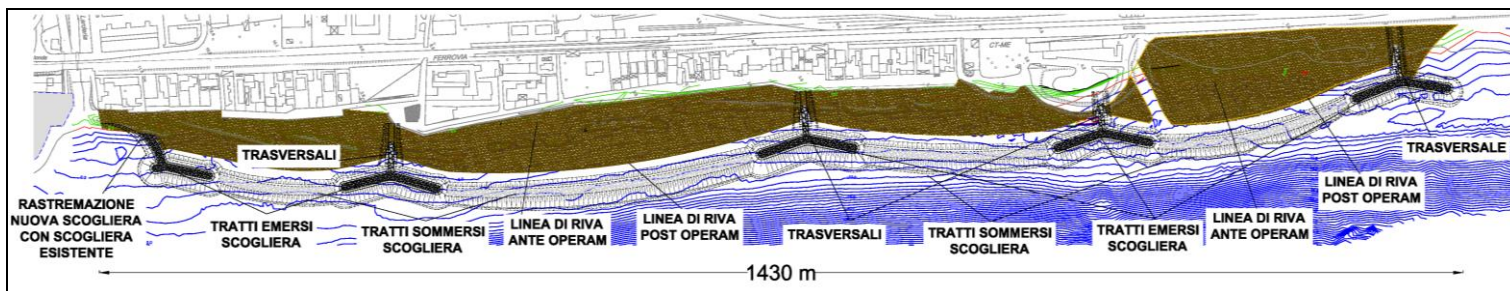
Planimetria di progetto del ripascimento protetto a Nord del porto esistente
